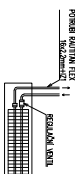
DETAIL NAPŮJENÍ TRUBKOVÉHO OTOPNĚHO TĚLESA
